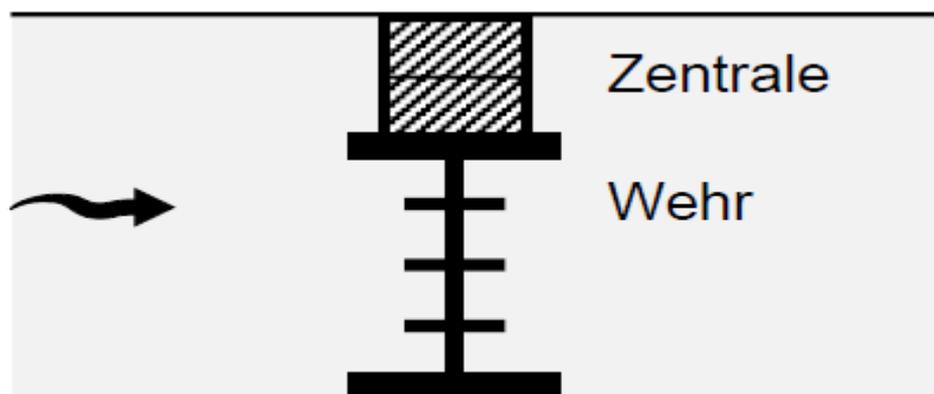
Blockbauweise (Quelle: Wasserbau FS 10)
